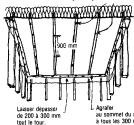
POSE DU PARE-VAPEUR AU PLAFOND
